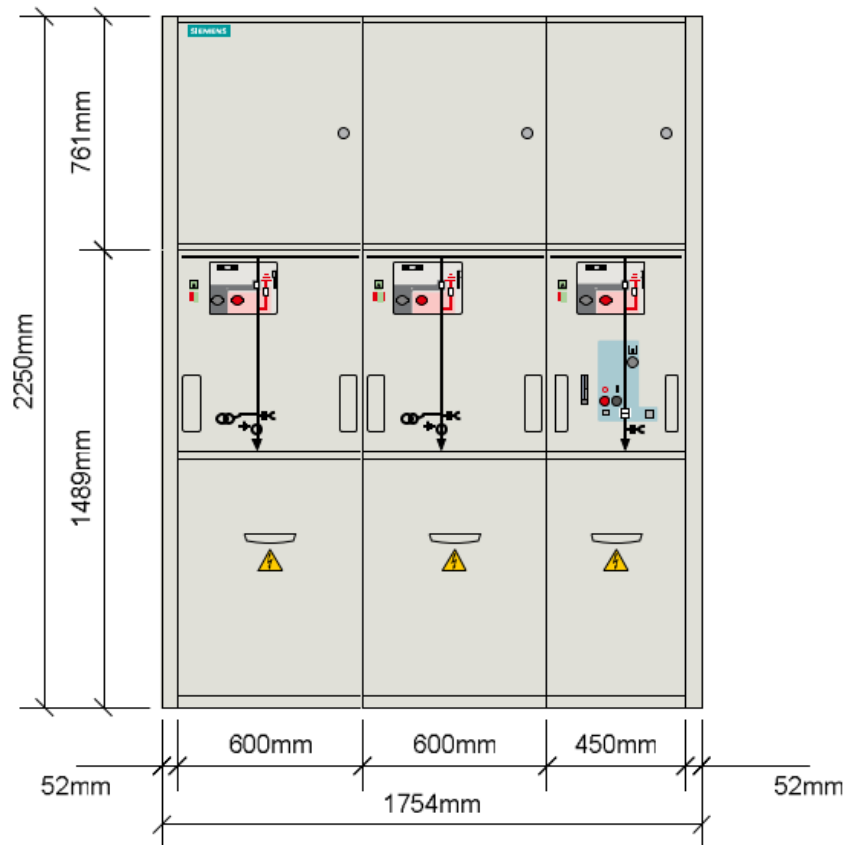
Vista frontal do Bloco Rede Anel equipado com aparelhagem de 1250 A
